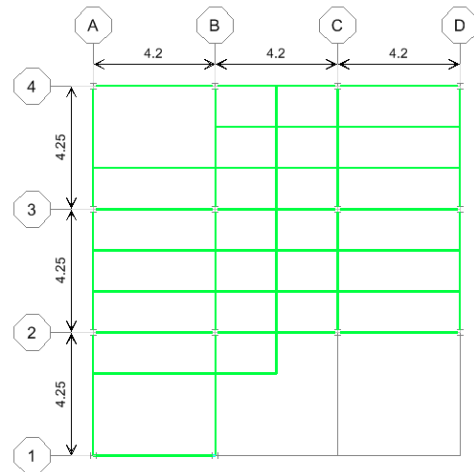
Planta 3000 y 6000 de la estructura Noroeste 3
